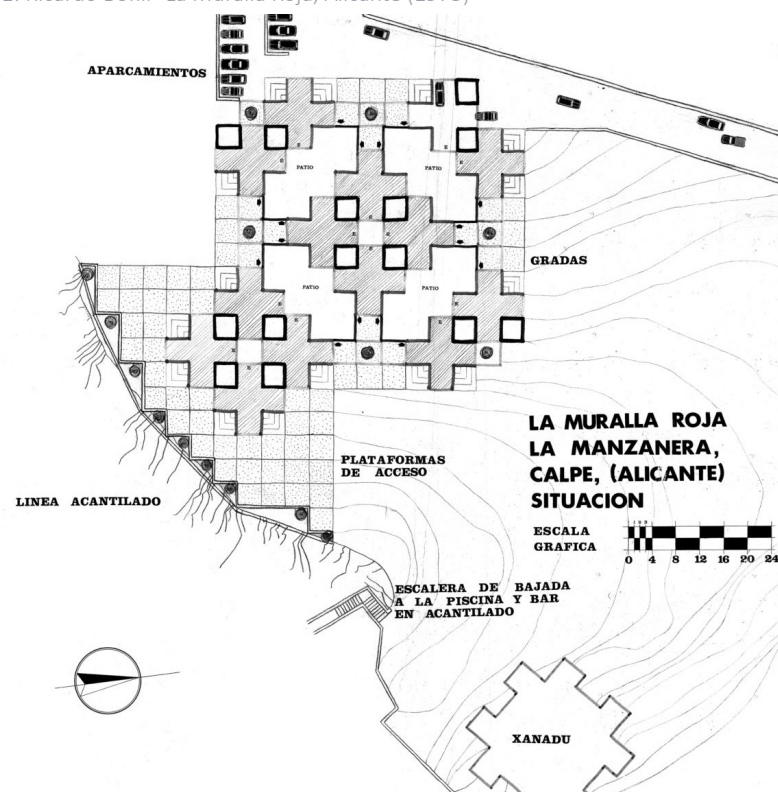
Ricardo Bofill - La Muralla Roja, Alicante (plan d'implantation)
